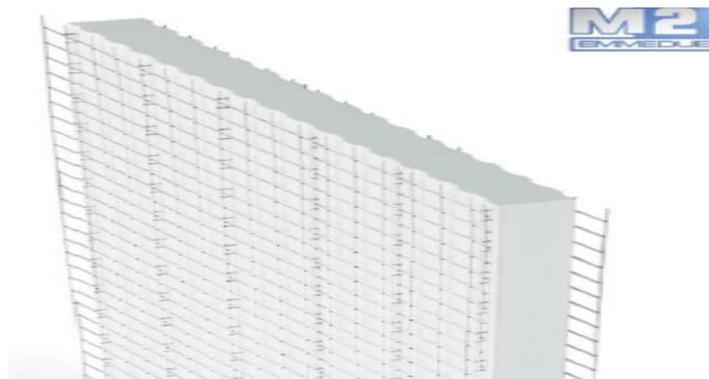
Panel estructural, trabaja como un muro portante estructural.
